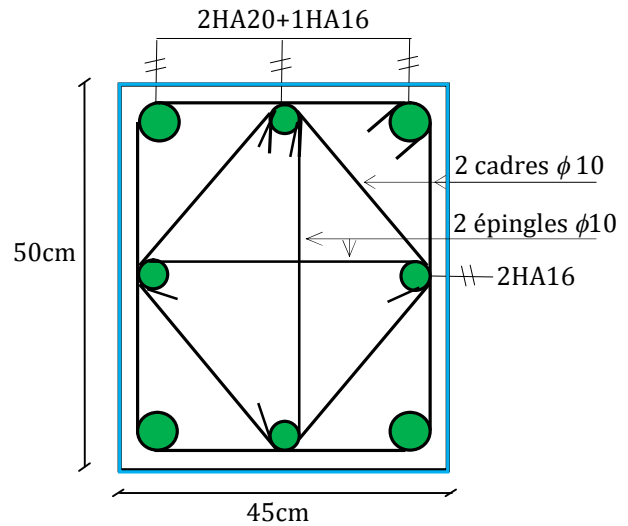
Schéma de ferrailage des poteaux 2^{eme}, 3^{eme} et 4^{eme} étage.
